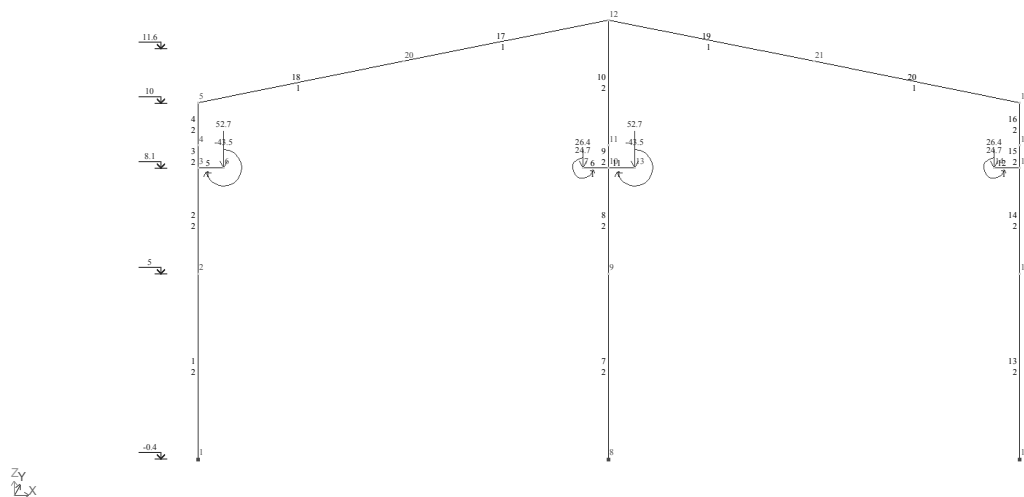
Схема нагружения поперечной рамы крановой нагрузкой (кран слева)
